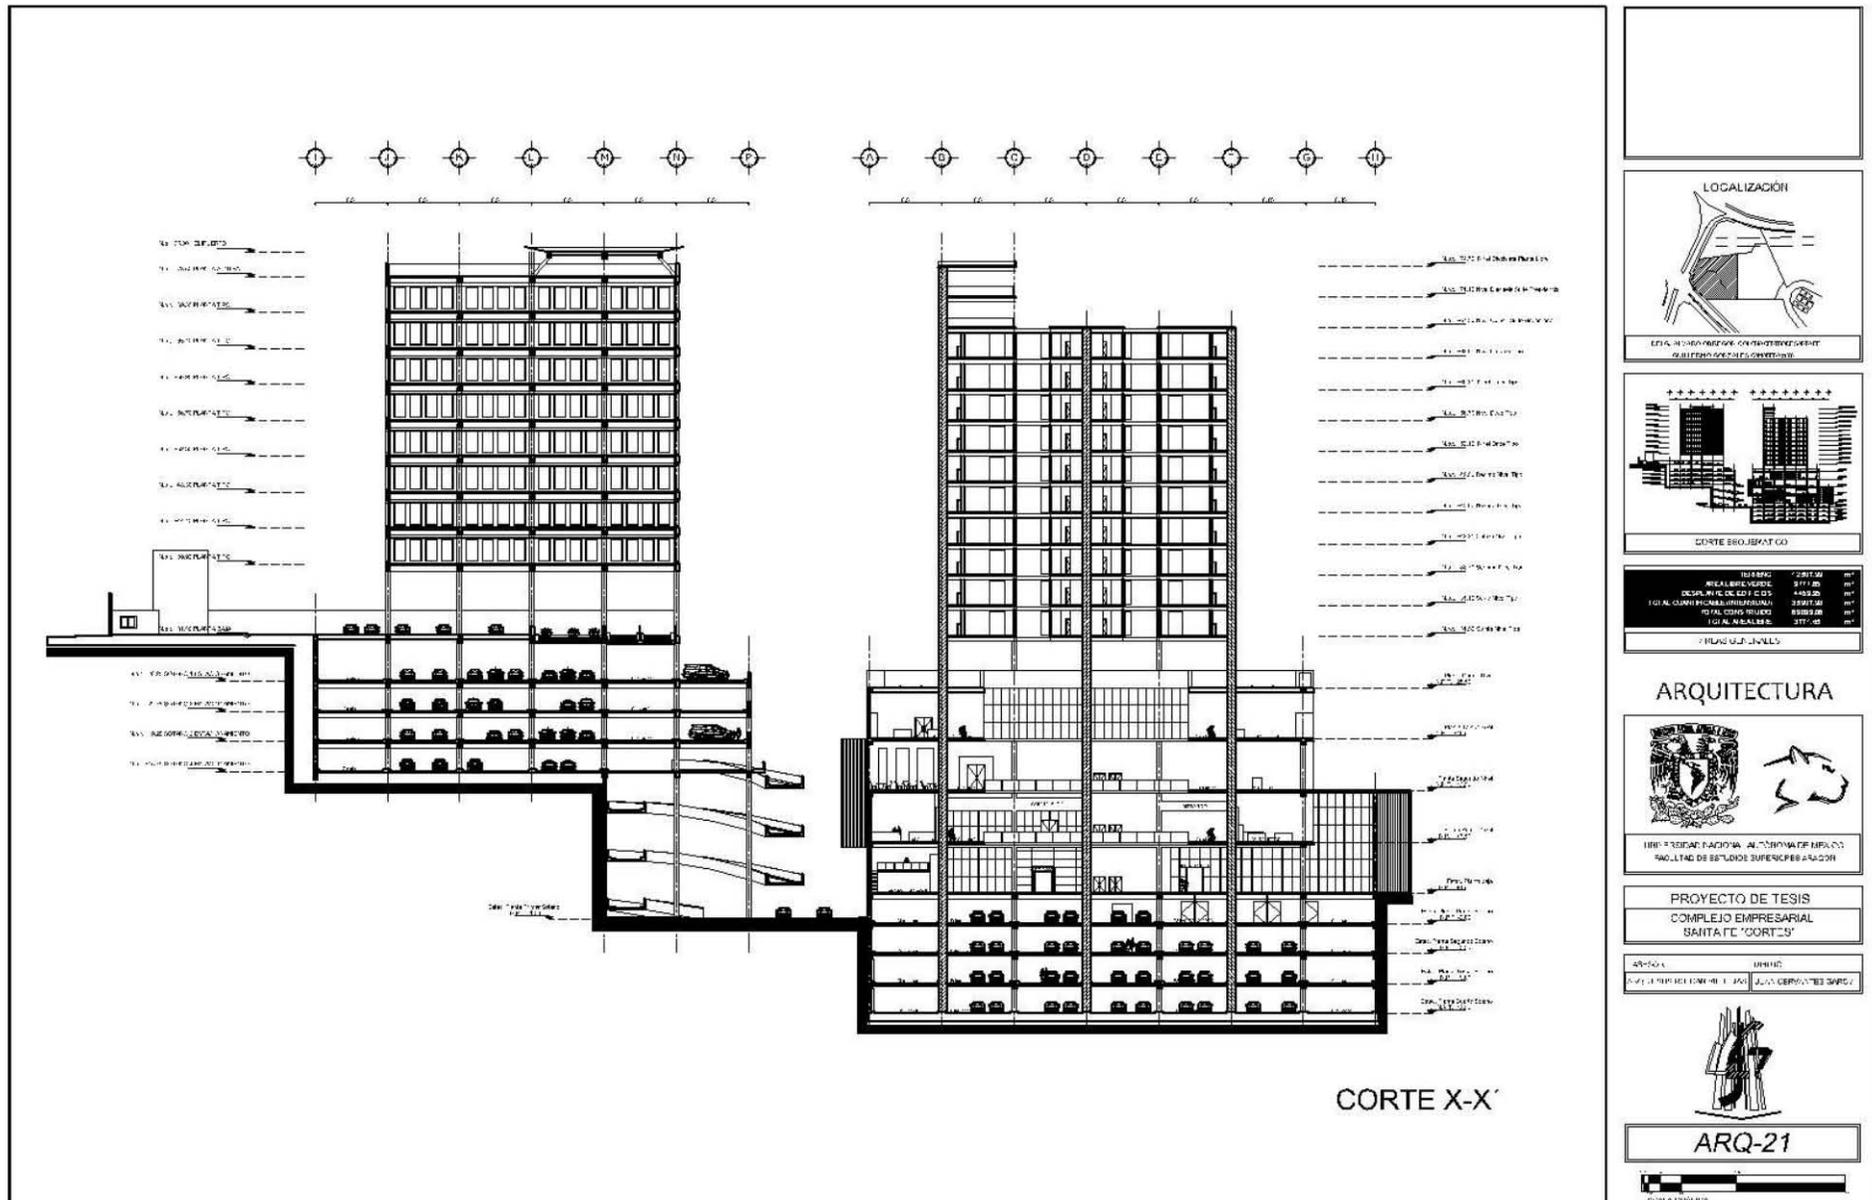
Plano ARQ-21; Corte X-X' Oficinas, Hotel y Centro Comercial. Edición propia.
